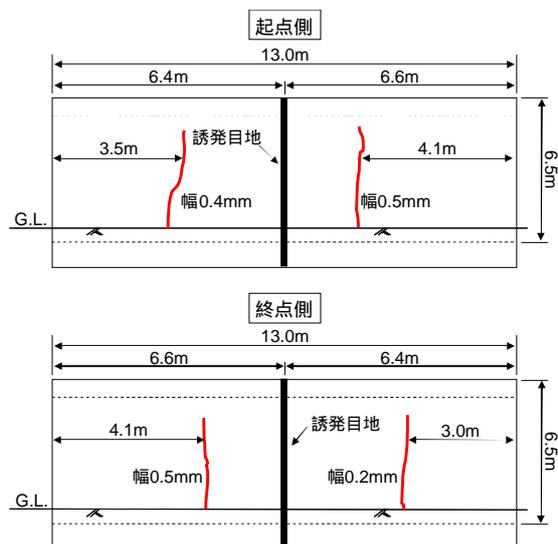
長期材齢のひび割れ発生状況（側面図）
